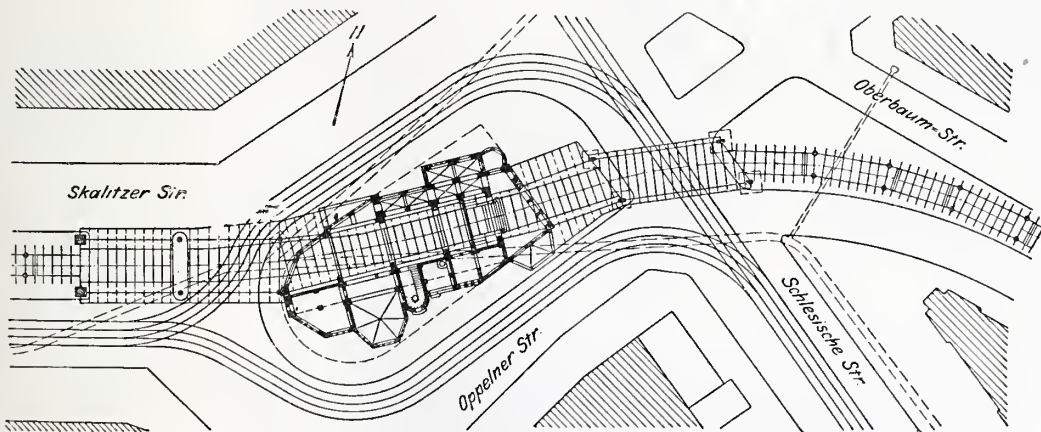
Haltestelle Schlesisches Tor. — Lageplan. Masstab 1 : 1500.
